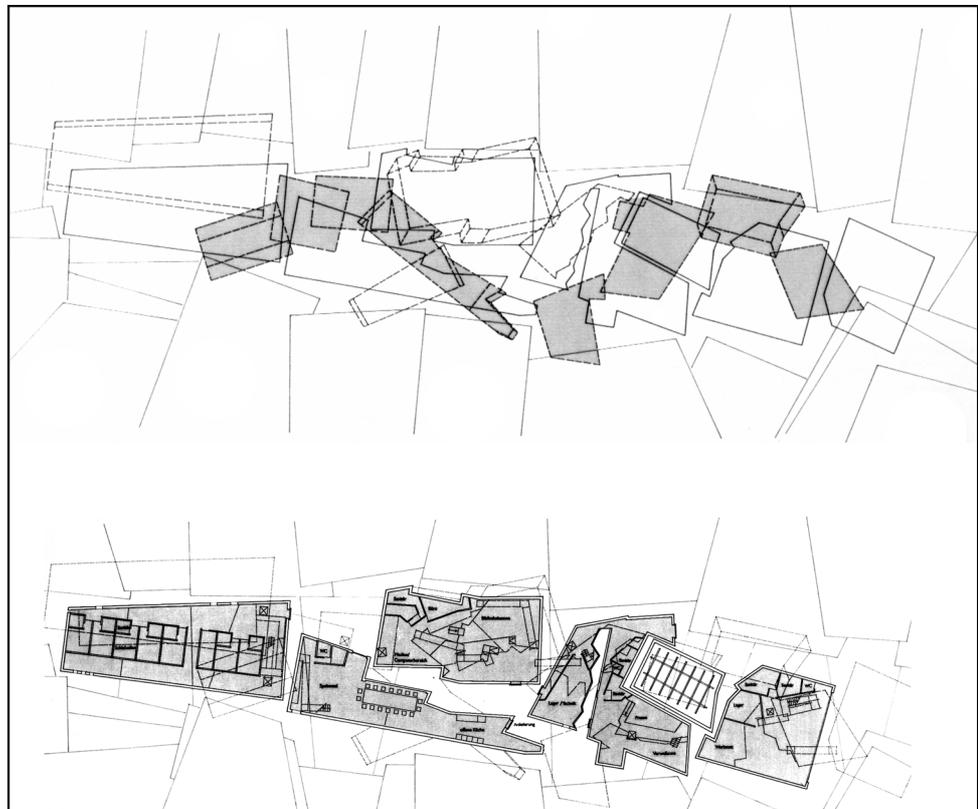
Mediale Vermittlung: Grundriss (Konzeptionsplan)⁶³
